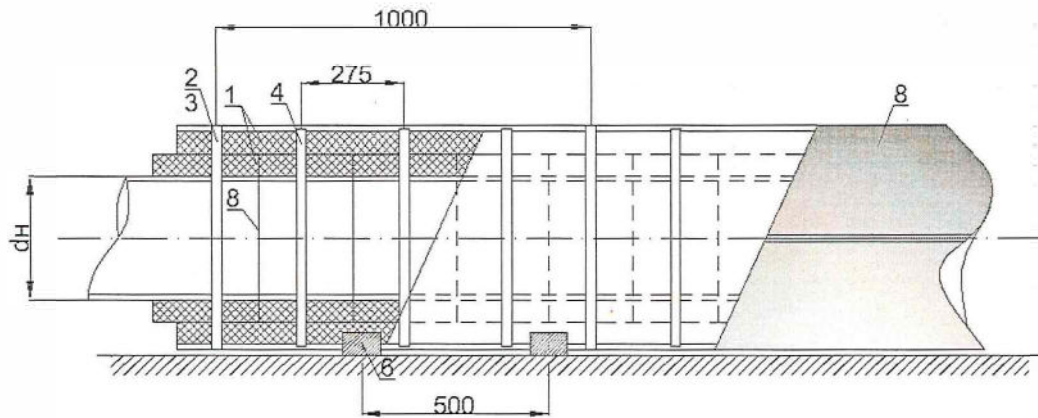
Изоляция трубопровода теплоизоляционными матами МПБ-БСТВ в один слой бандажными лентами и проволочной стяжкой,
